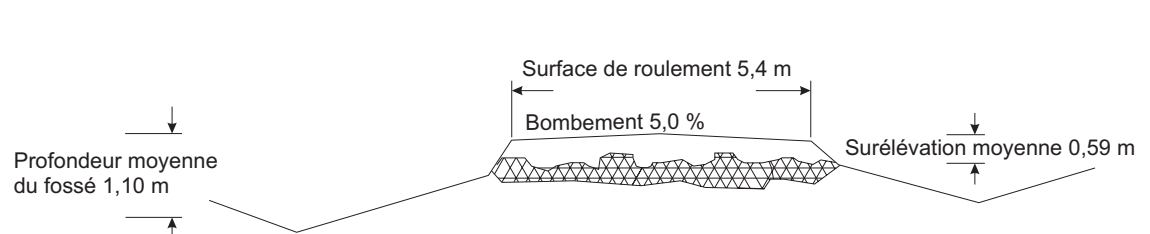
Profil transversal type d'une route à Surélévation-sur-enracinement, telle que construite.
